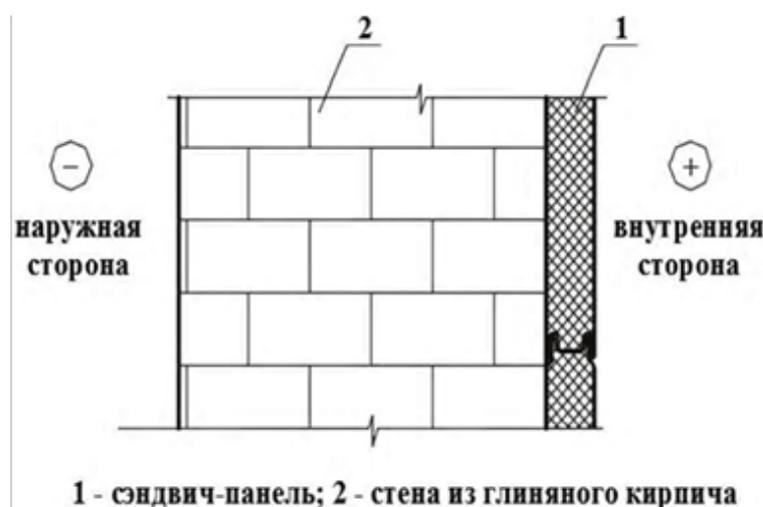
Конструктивная схема наружной стены зданий с внутренним теплоизоляционным слоем
